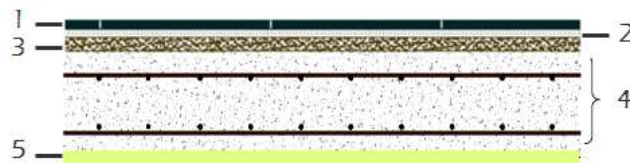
Coupe d'un plancher en dalle pleine (inaccessible).
